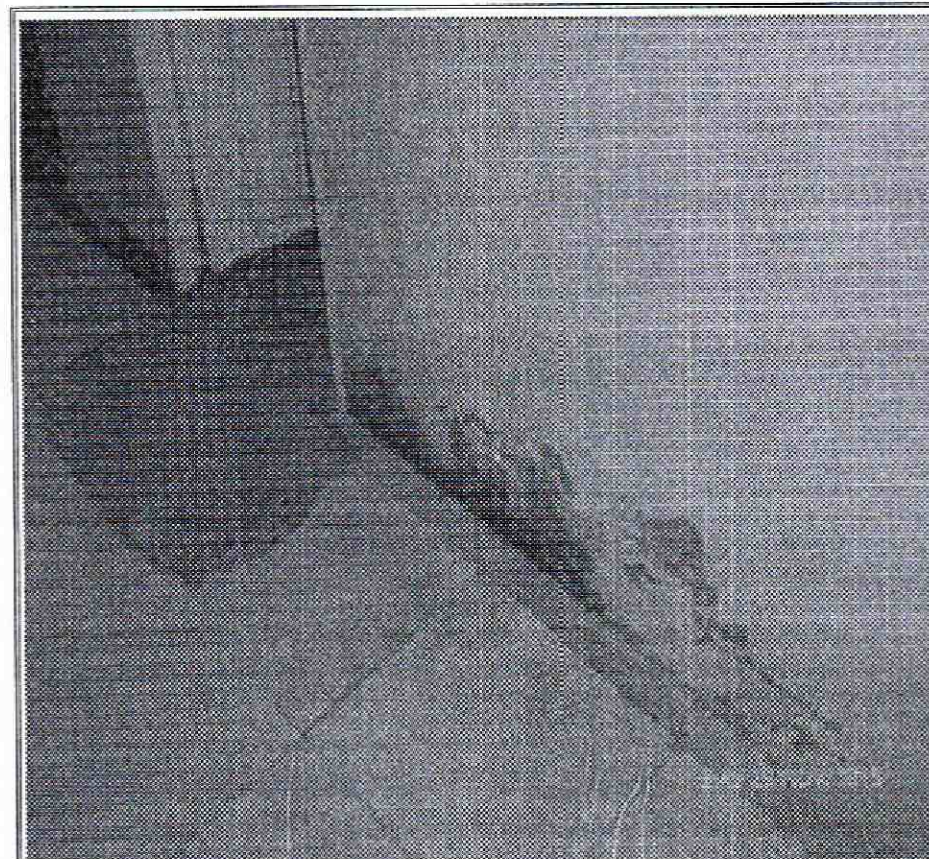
Humedades en muros perimetrales y divisorios de la vivienda de la Calle 1 Bis A No. 1 - 57 Este
